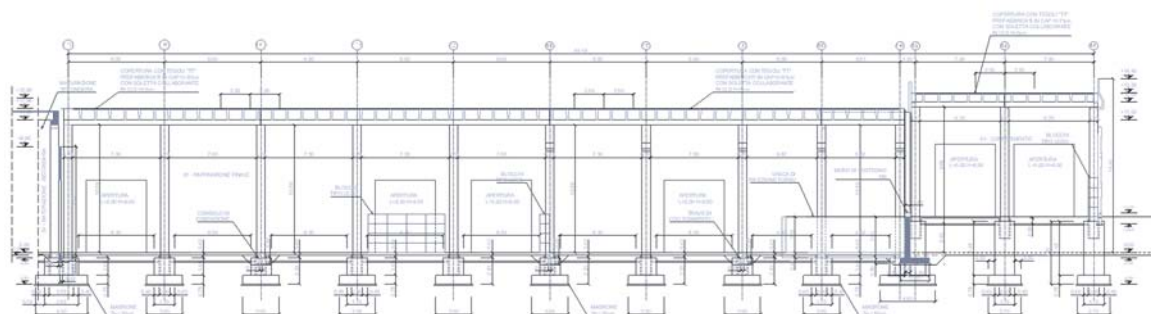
SEZIONE LONGITUDINALE CONFERIMENTO E RAFFINAZIONE
